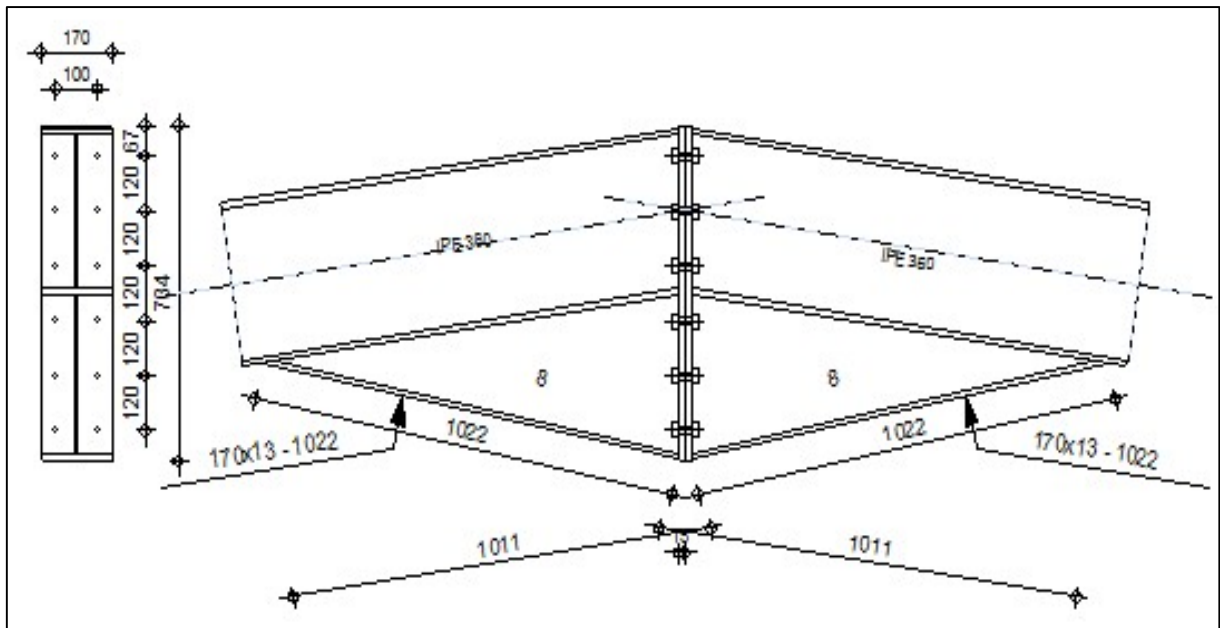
Vue en Plan de l'assemblage traverse - traverse.
